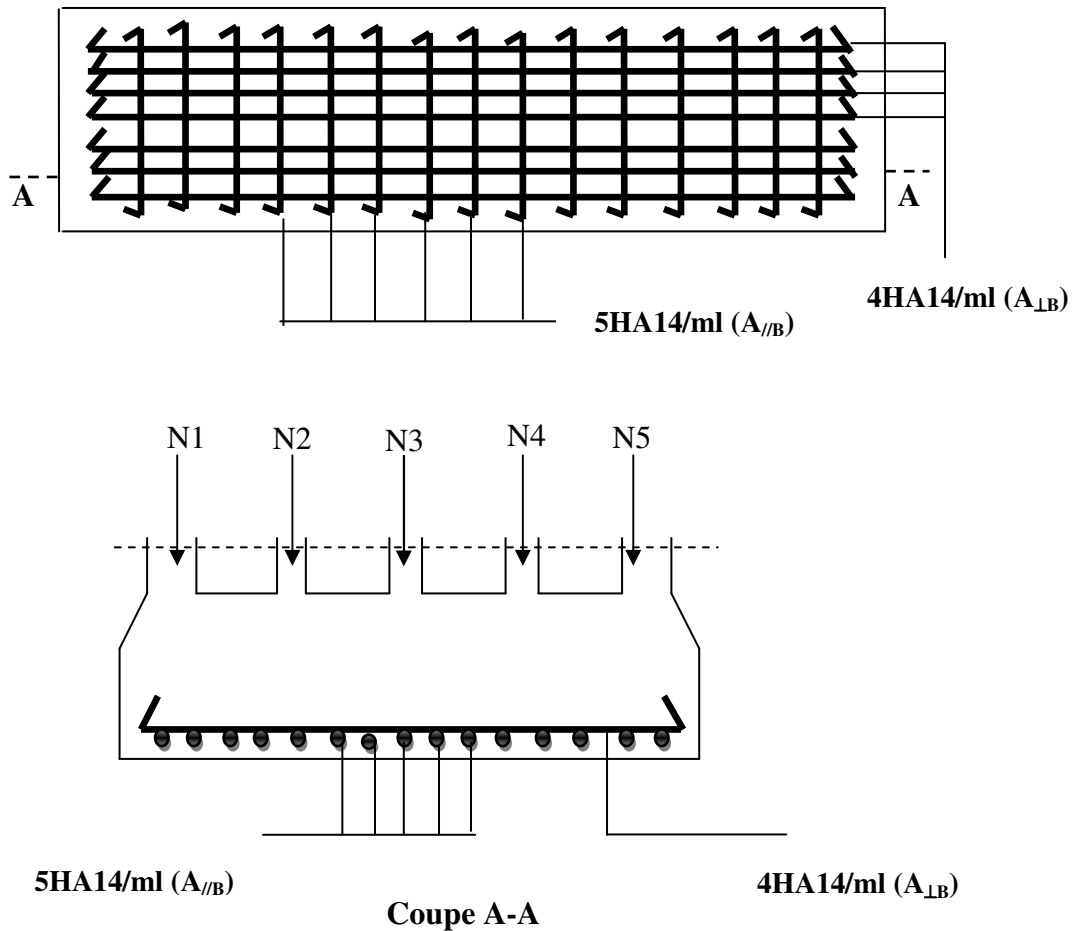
Schéma de ferrailage de la semelle filante sous poteaux.
